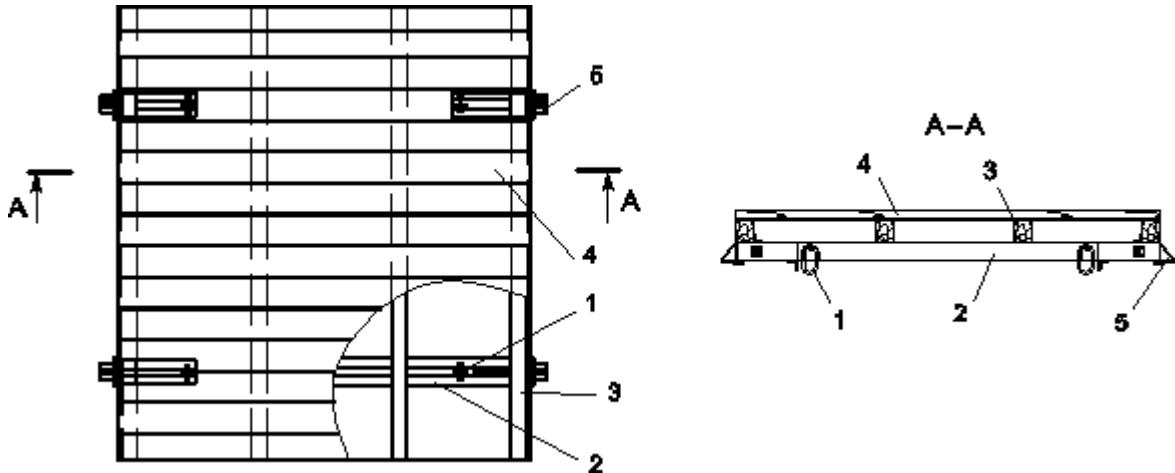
Схема укрупненого робочого майданчика опалубки ліфтових шахт: 1 – петля для стропування; 2 – балка майданчика ліфта; 3 – дерев'яна балка настилу; 4 – настил з дощок; 5 – упор
